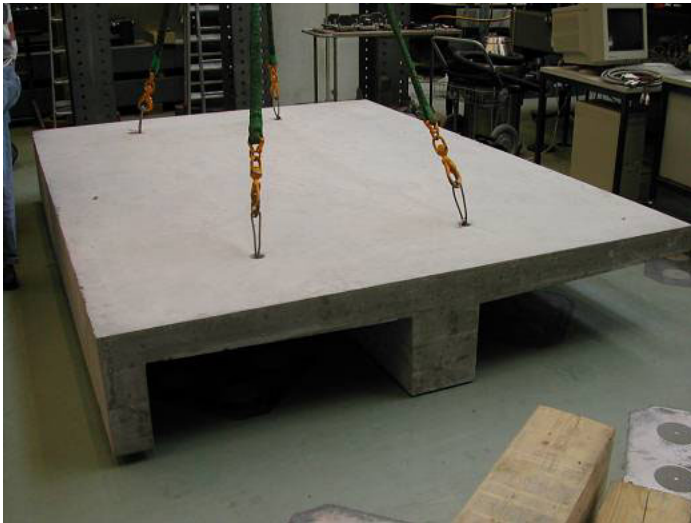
Arrivée de la structure à l'halle de l'essai.
